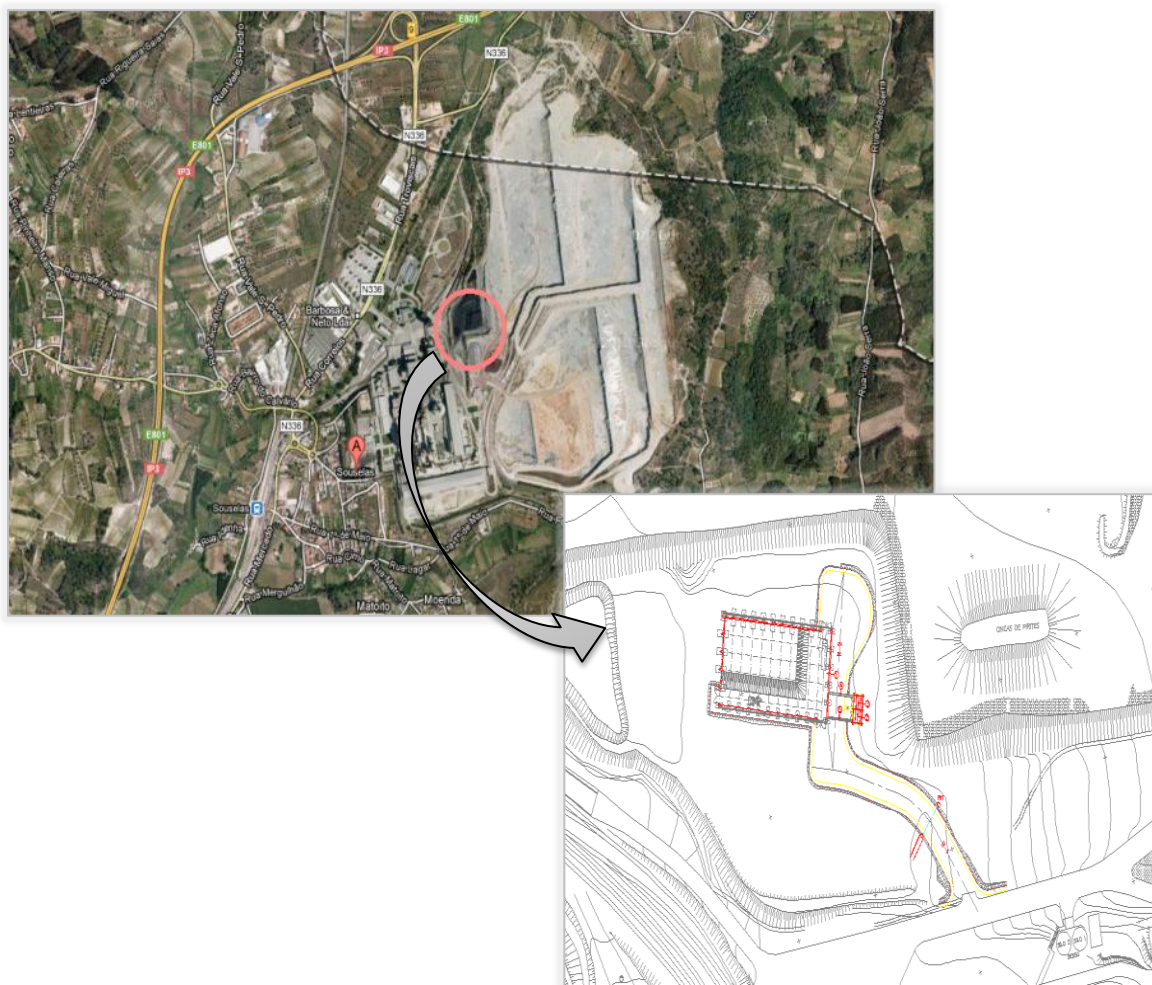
Localização e planta de implantação do futuro pavilhão.
